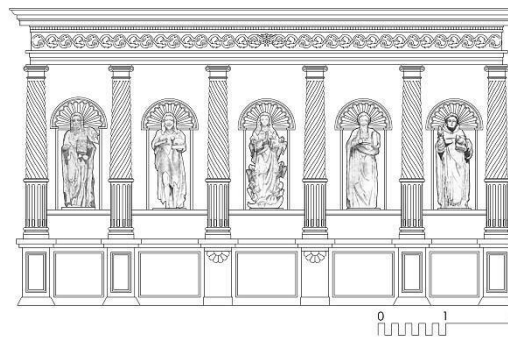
Dibujo del segundo piso de la fachada retablo
